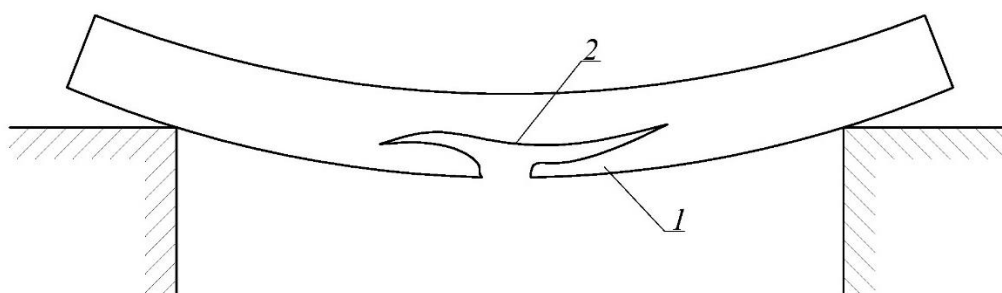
Разрушение пролетной части деревянной балки: 1 – деревянная балка; 2 – разрыв и отслоение растянутых волокон
